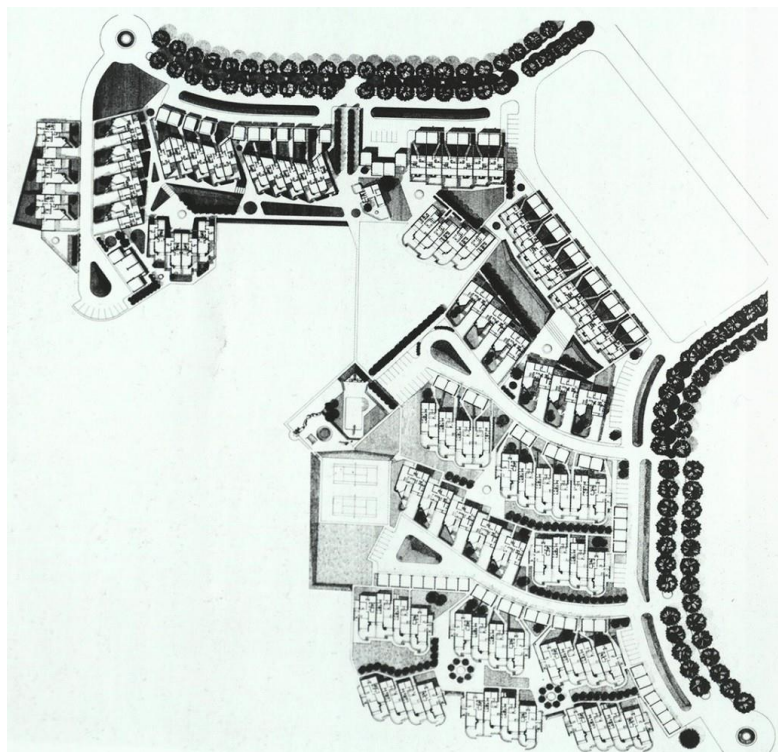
Antoine Predock, plan du site de La Luz, 1967. Source: Brad Collins, éd.,
